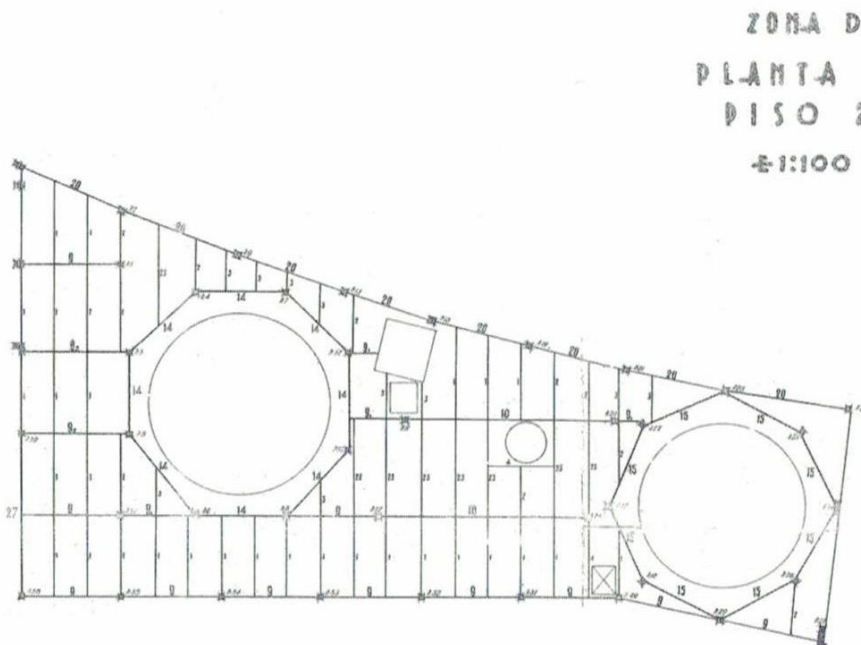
Plano de la estructura de la zona D. (ALT 1940/02)
